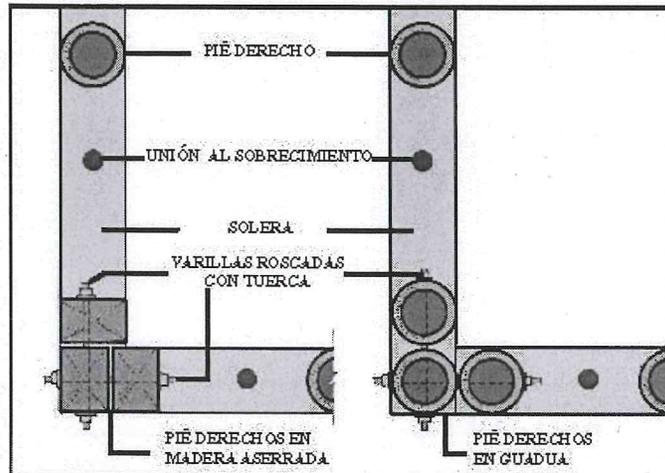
Vista en planta - Unión de muros en planos perpendiculares – Esquina.
